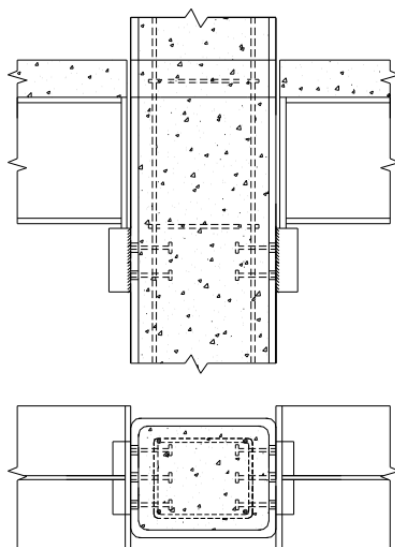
Ligação de Consolos em Pilar Misto Tubular. (ABNT NBR 14323:2013)
